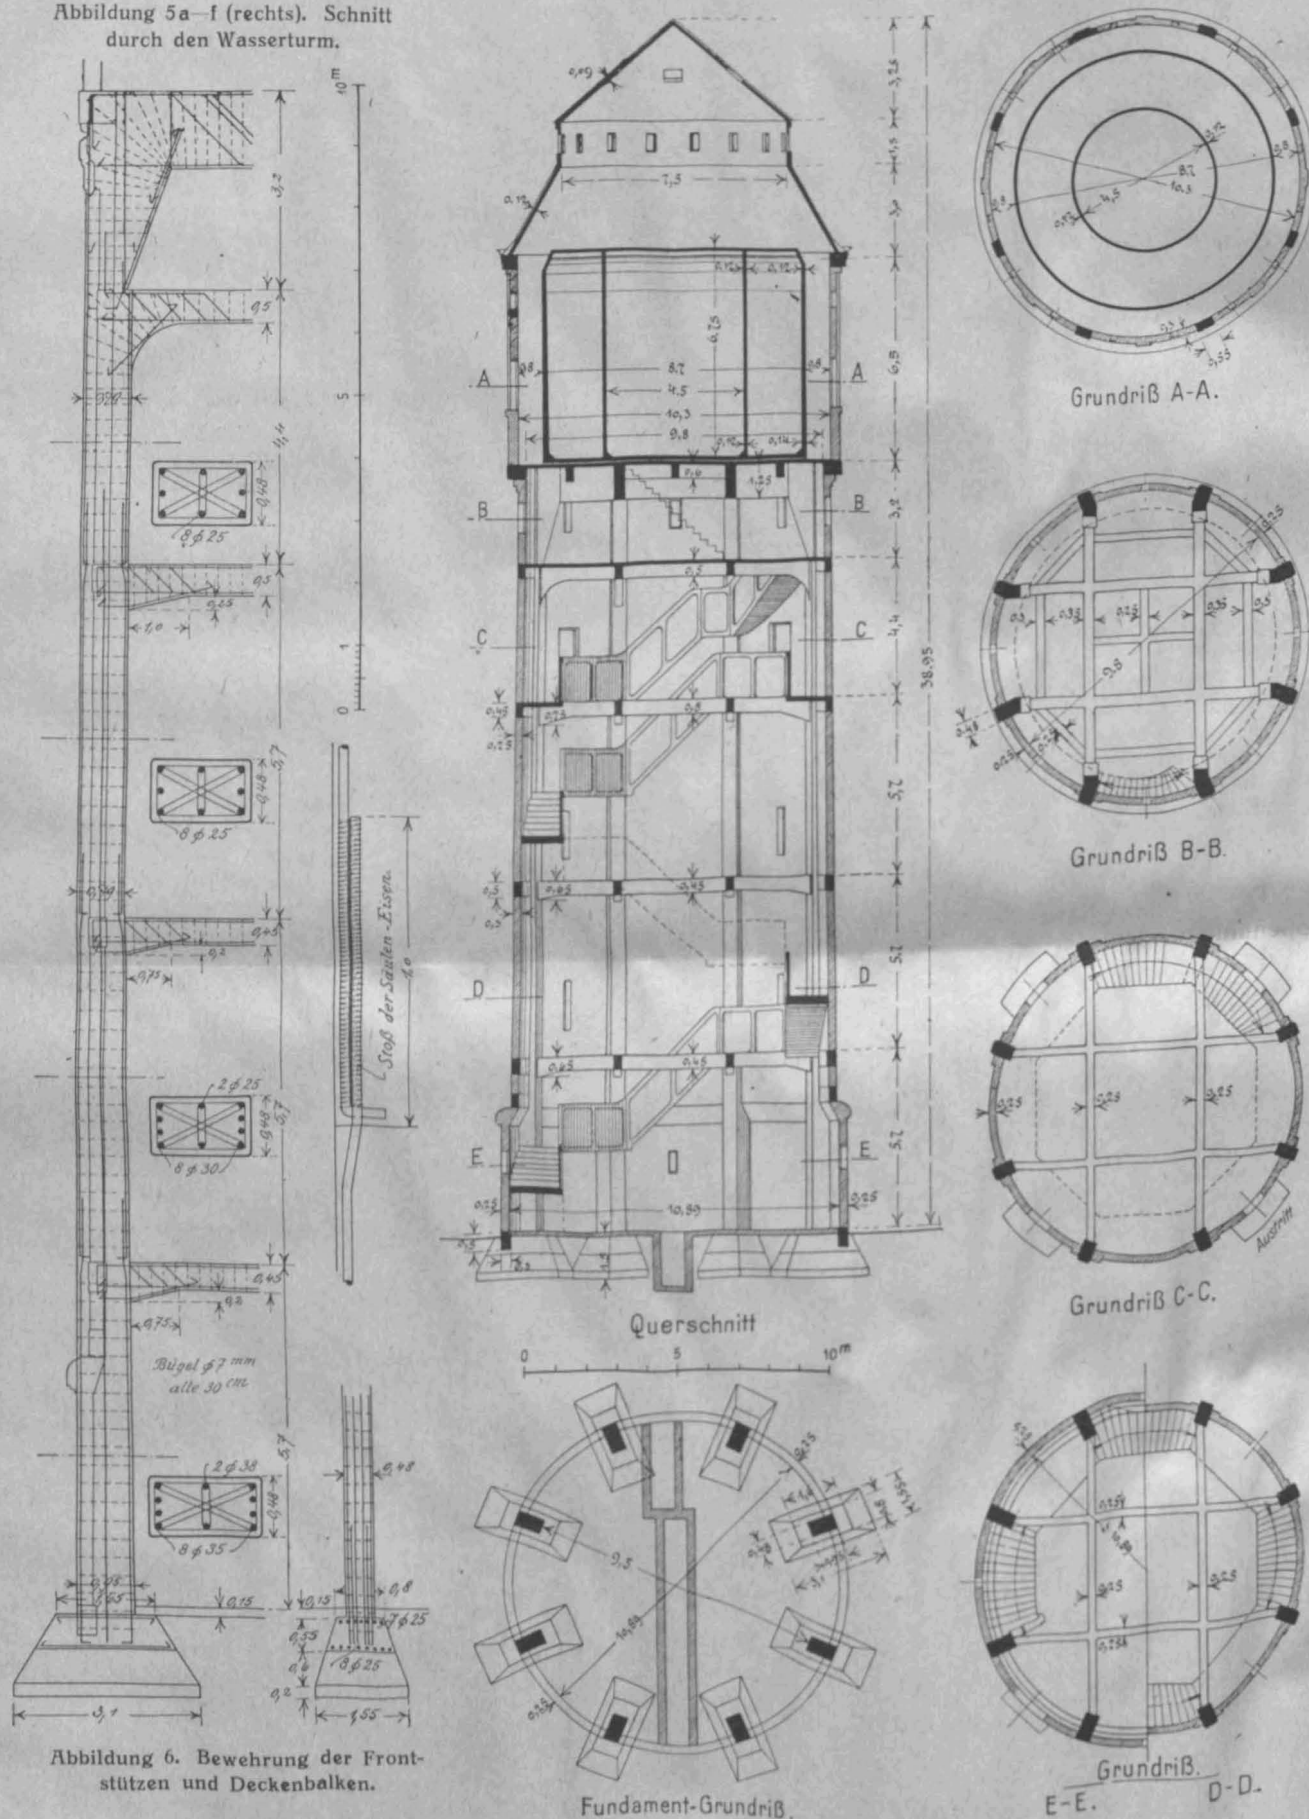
Bewehrung der Frontstützen und Deckenbalken.
